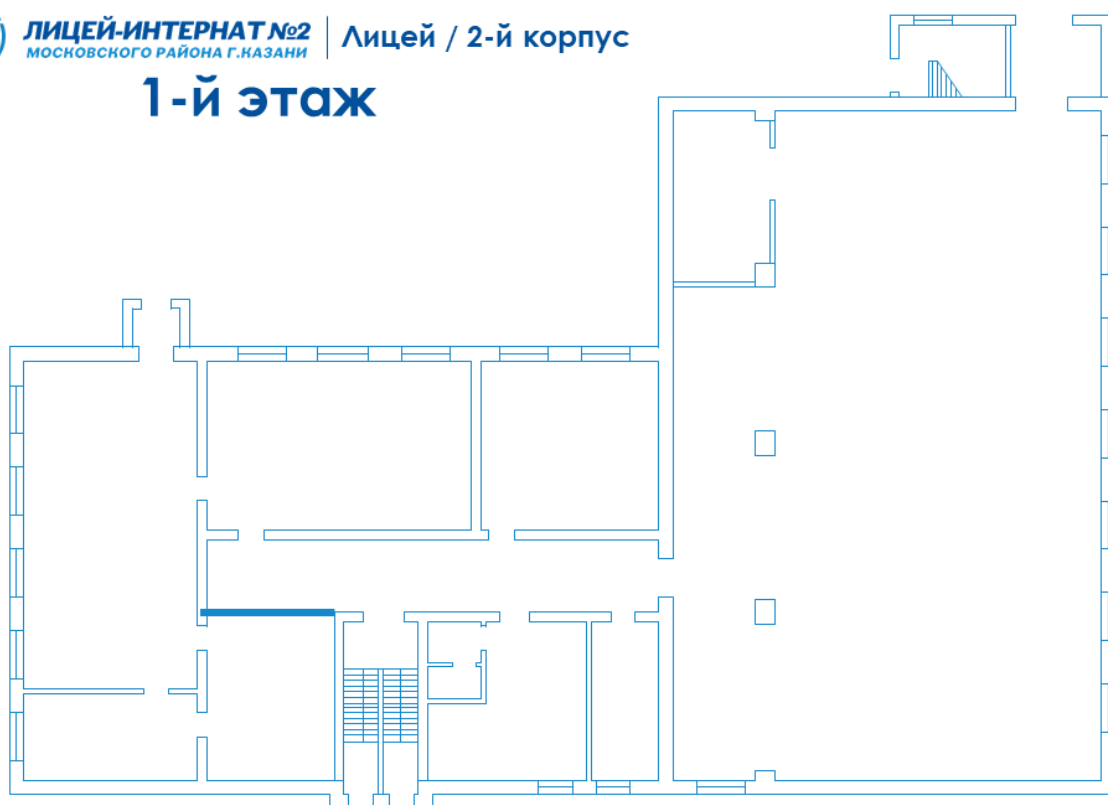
1 этаж, 2-го корпуса лицея
